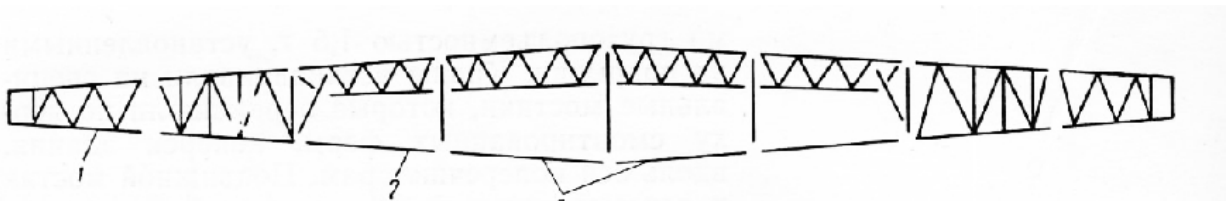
Схема членування ферм: 1 - консольна частина ферми; 2 - опорні сегменти ферми; 3 — сегменти ферми, що попередньо укрупнюються.
